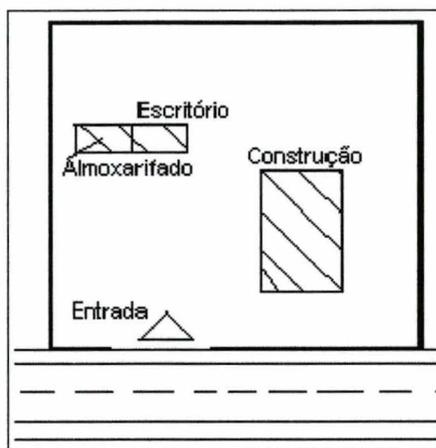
Layout* do canteiro de obra da laje protendida moldada no local.
